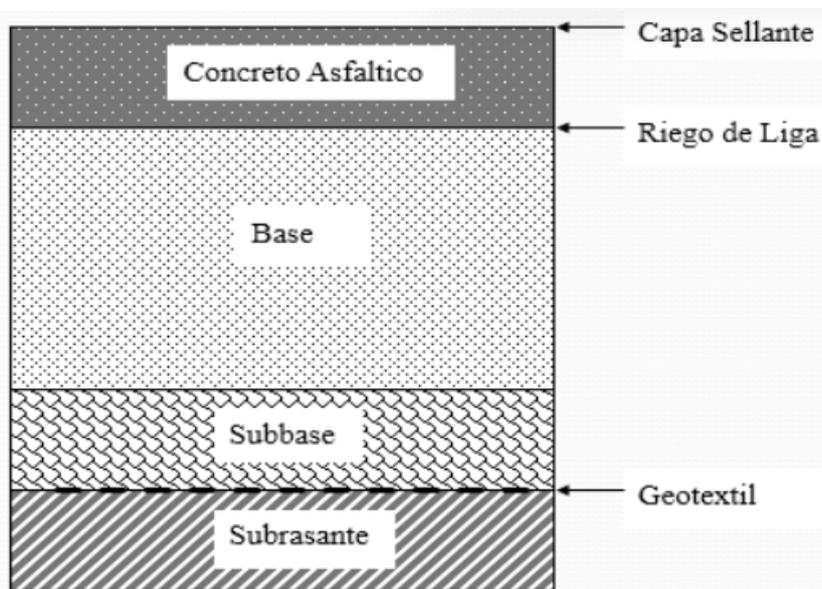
Estructura de un pavimento rígido. Fuente Introducción a la ingeniera de pavimentos, Ing Andres Sotil Ch.
